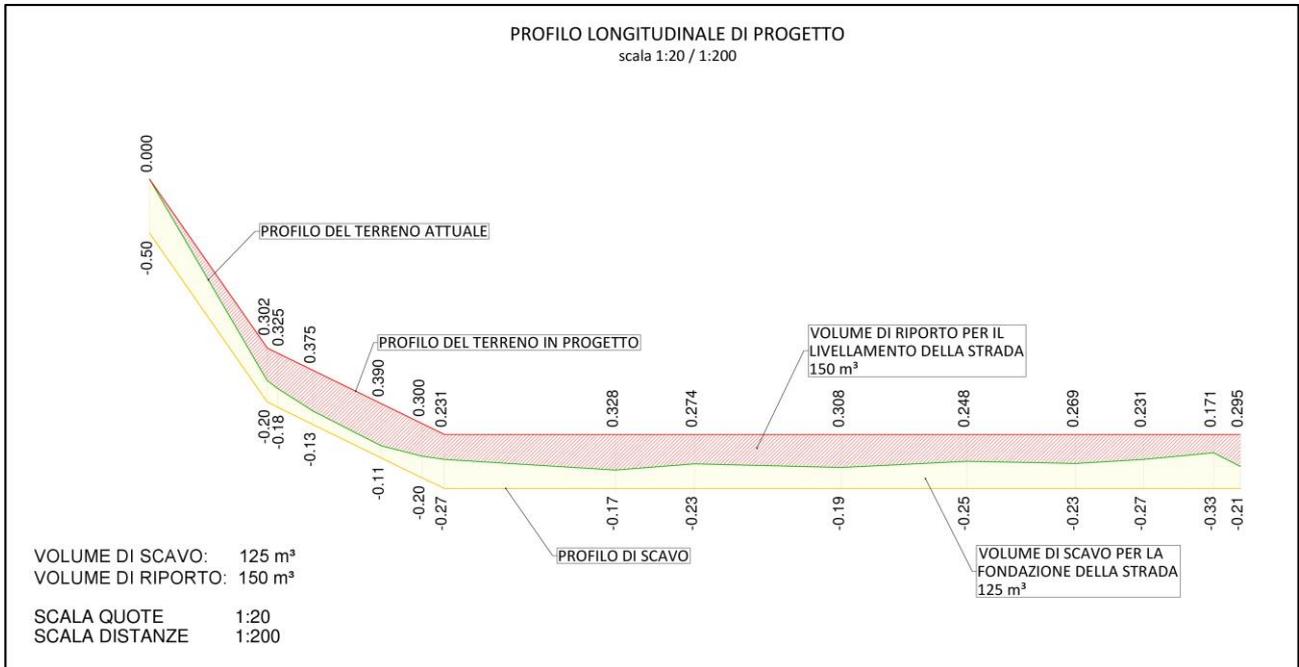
Estratto "Tav.04 - Profilo longitudinale"
